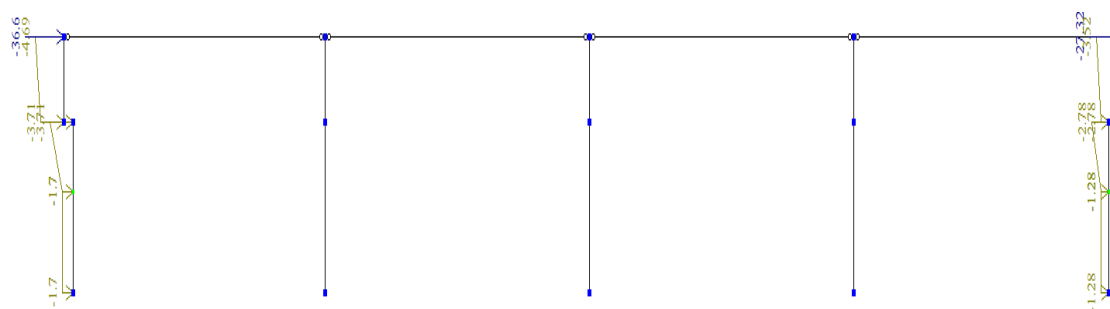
Розрахункова схема будівлі від вітрового навантаження
